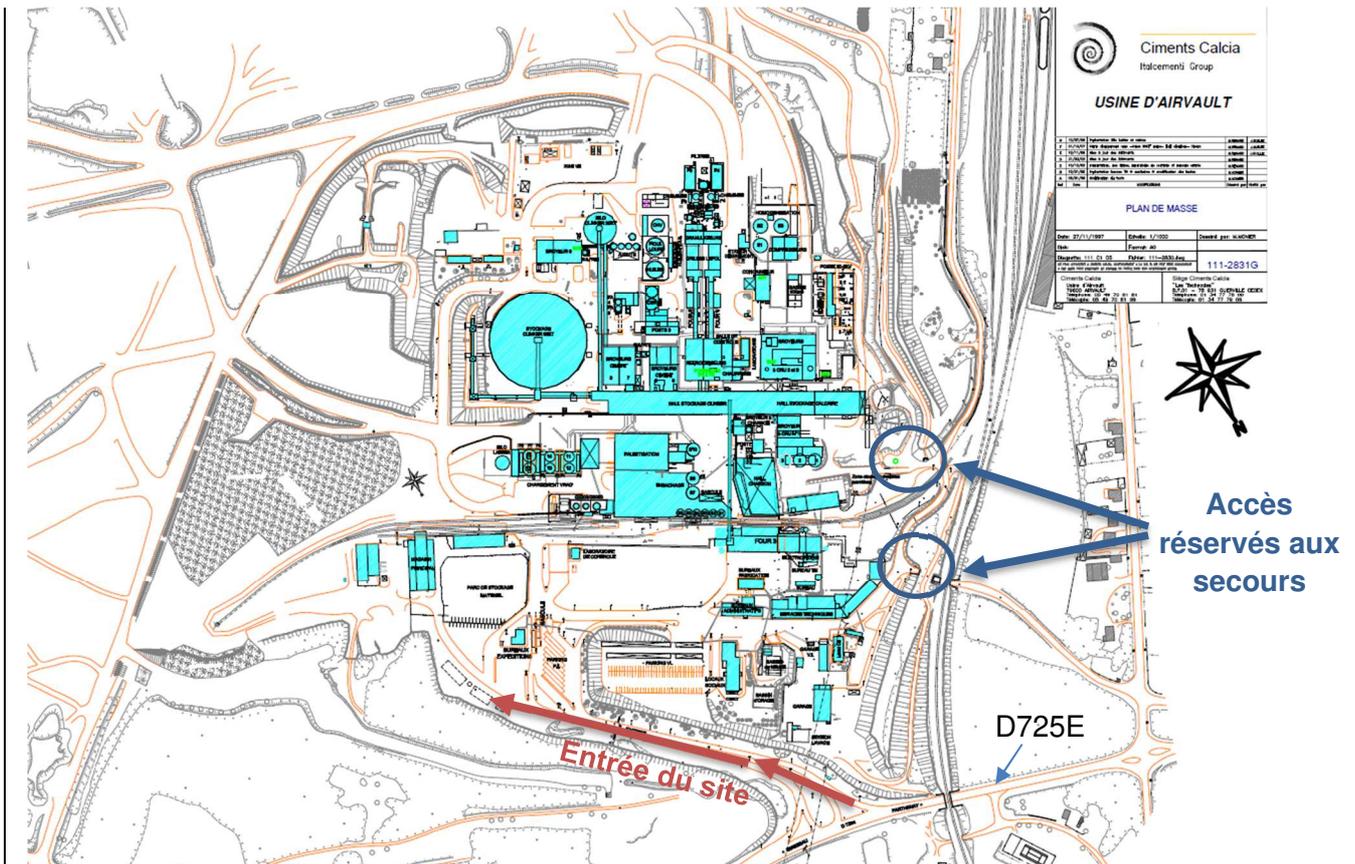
Plan du site actuel avec localisation de l'entrée – Echelle 1/1 000^{ème} (Sources : CIMENTS CALCIA)
